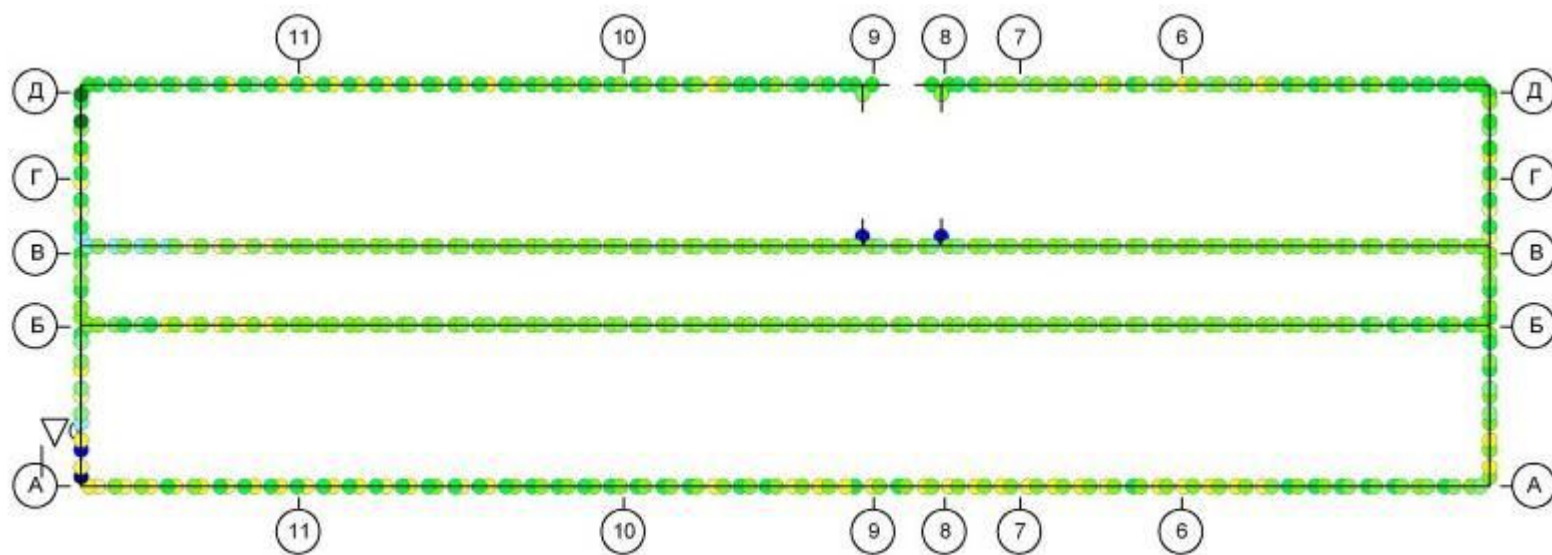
Нагрузка от внутренних стен на ленточные фундаменты здания в осях «12-5/А-Д» от комбинации загрузжений С5, тхм².
